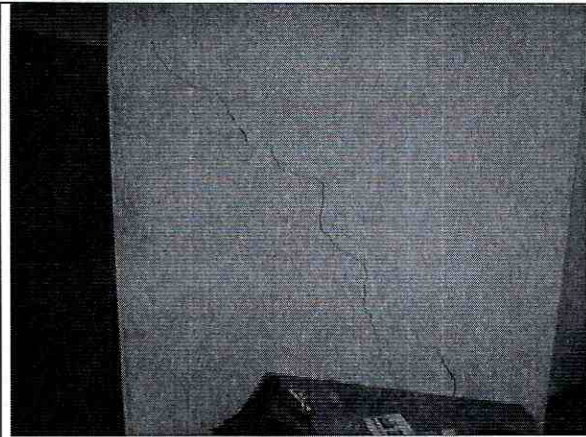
Agrietamiento en muro de segundo piso.
